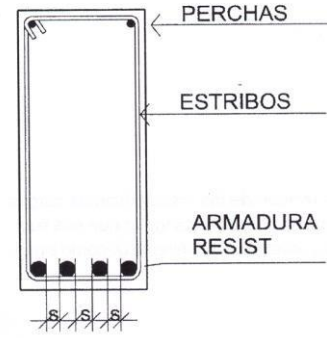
Armadura de las vigas de hormigón armado.
